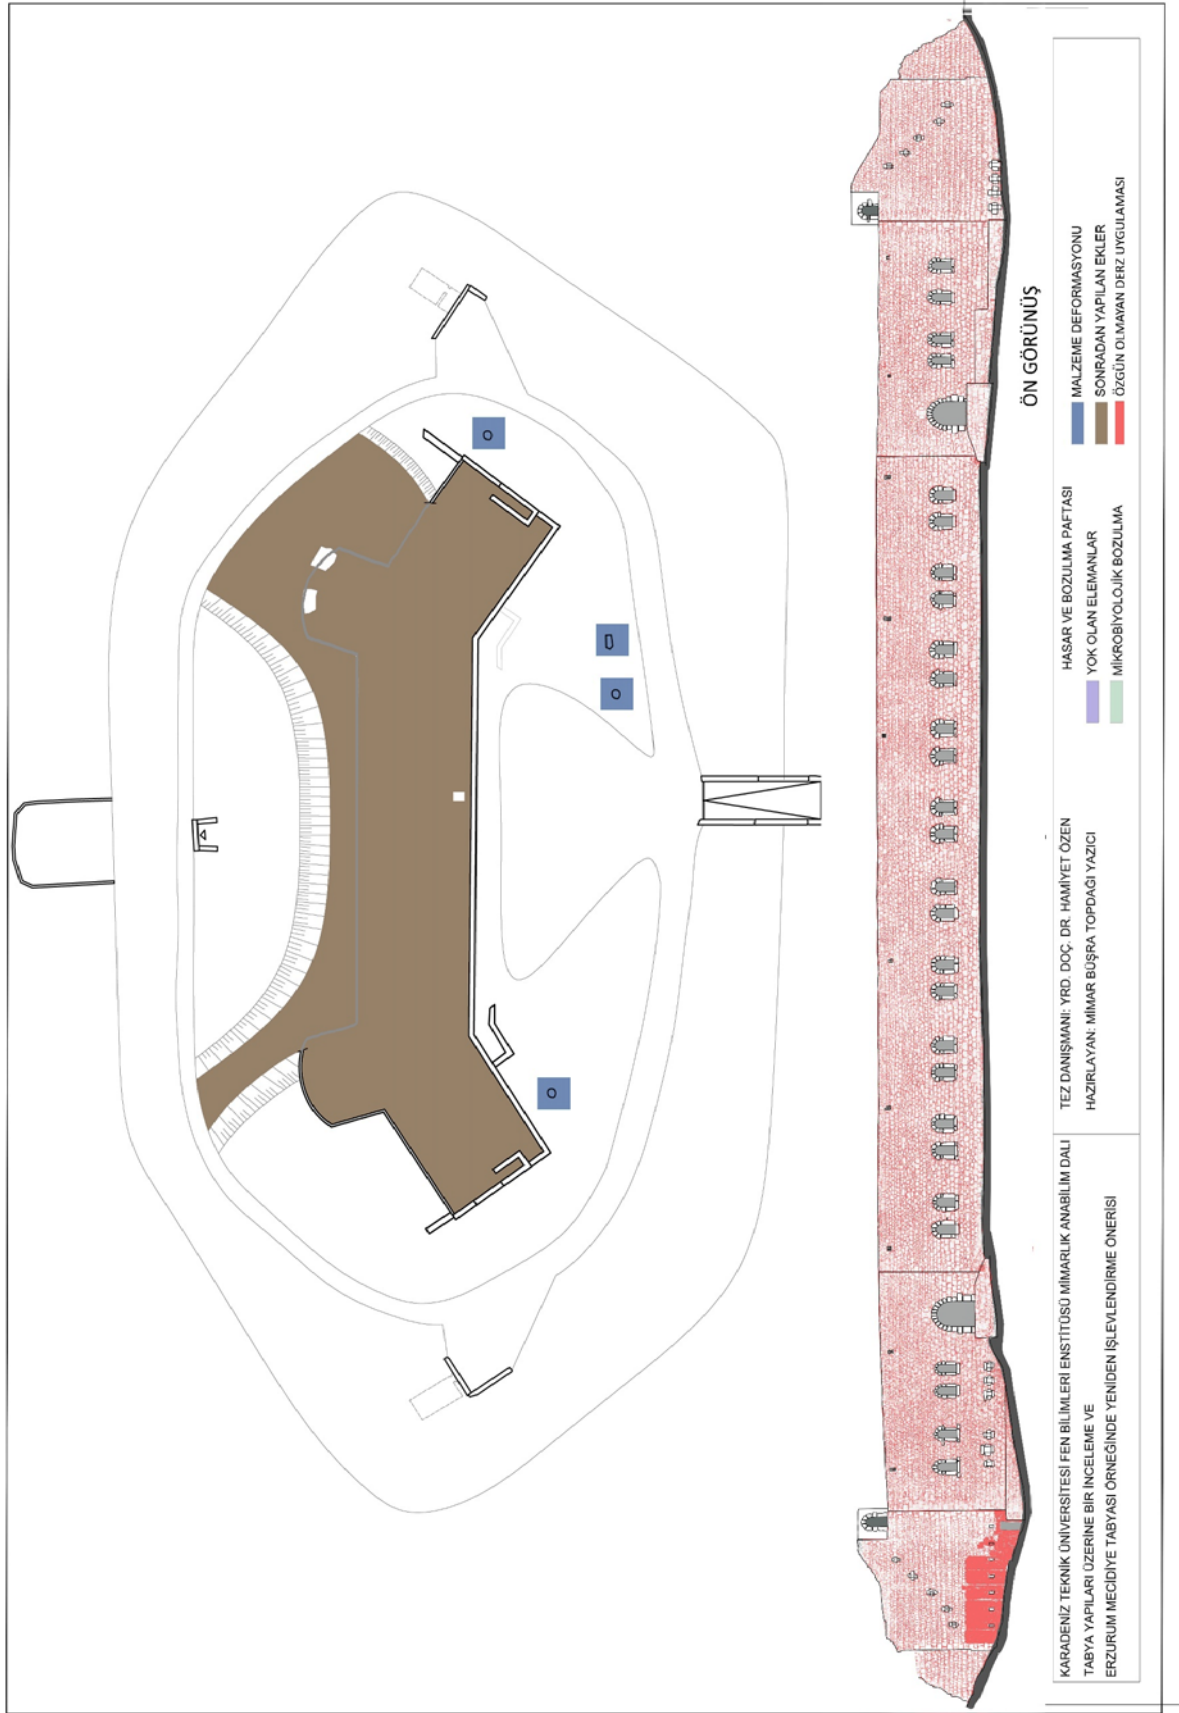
Zemin kat planı ve kesitler rölöve çizimleri
